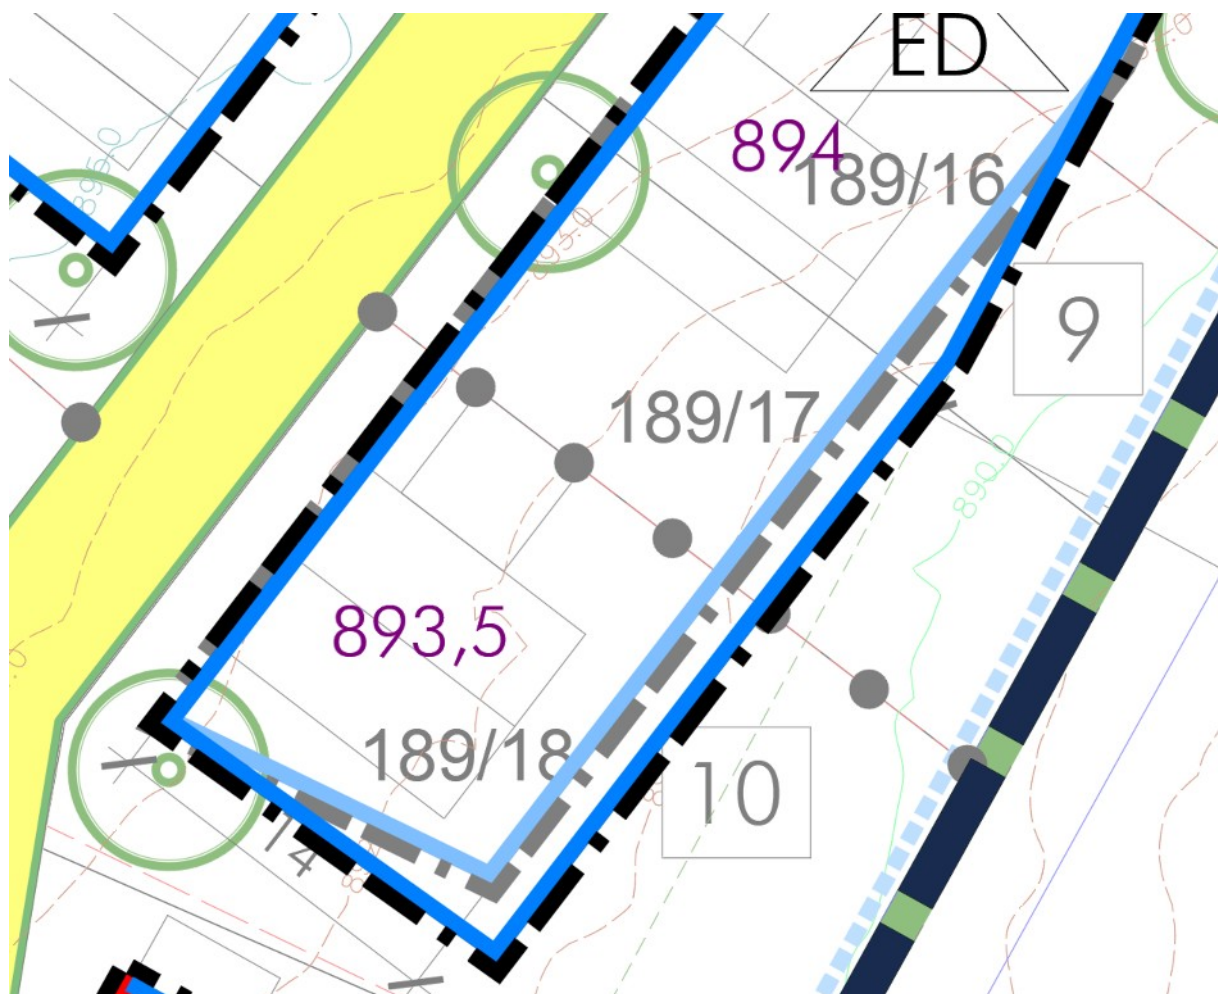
Bauplatz 9+10. Überlagerung der Planzeichnungen "Am Grohholz" und erste Änderung, unmaßstäblich
